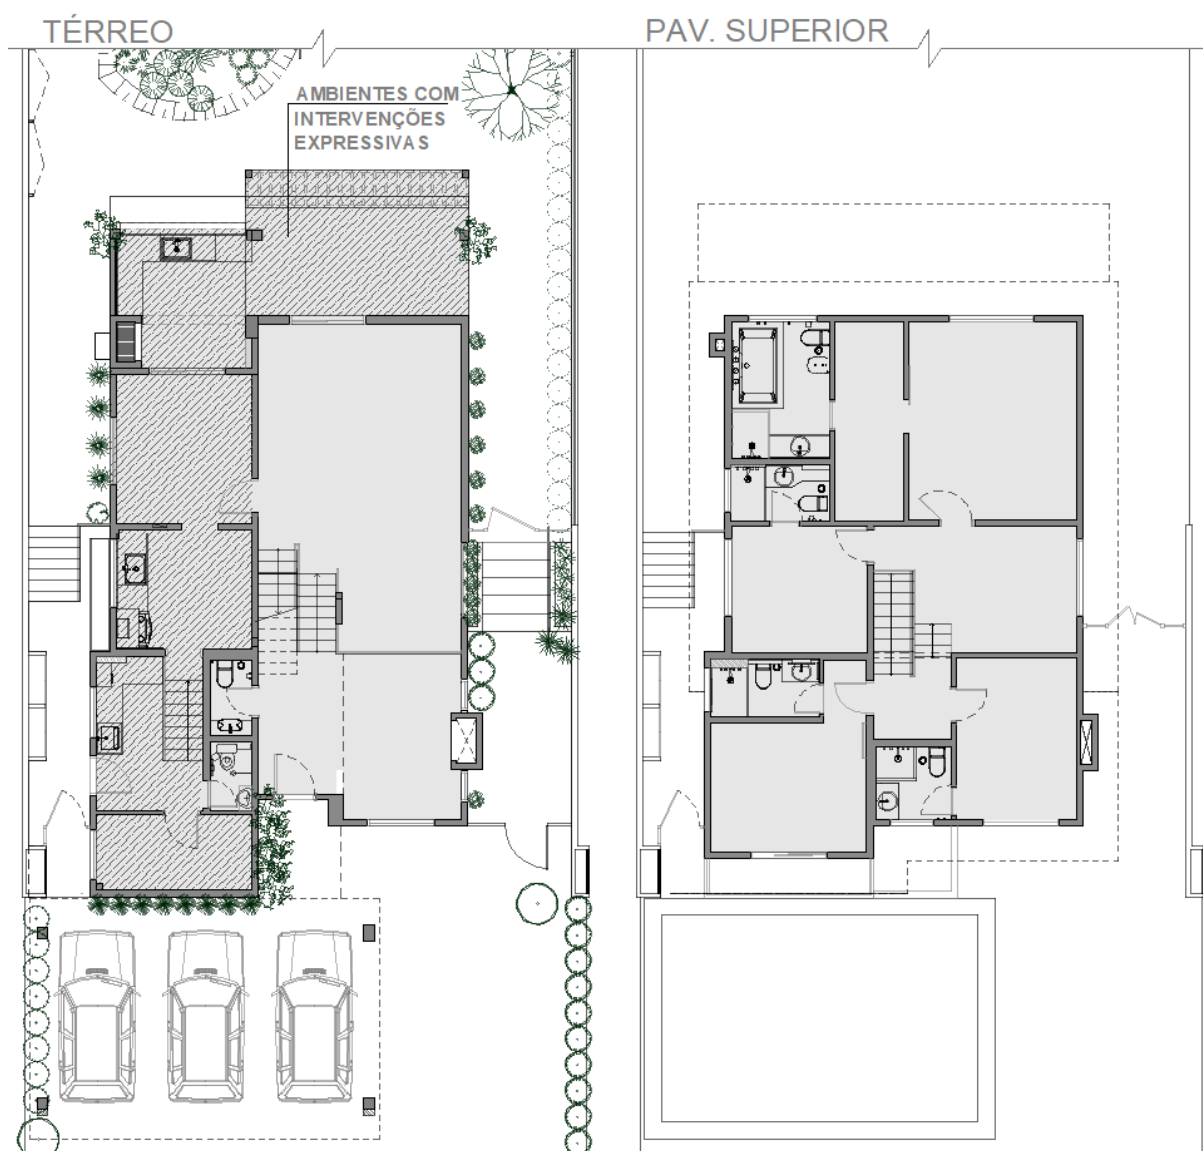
Estudo de Caso A – Plantas dos pavimentos com indicação das áreas com intervenções expressivas
